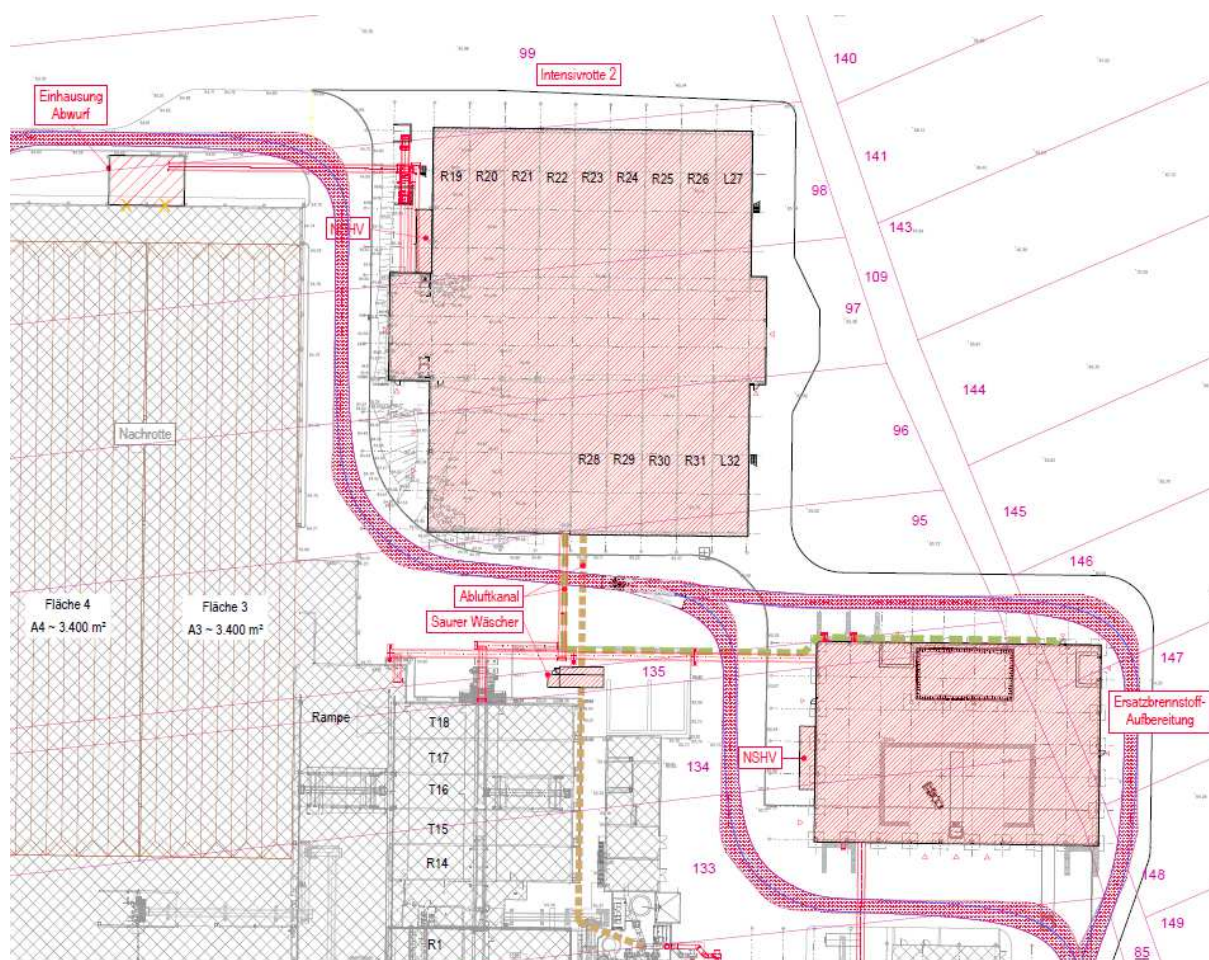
Geplante Erweiterung der MBA (technischer Lageplan)
